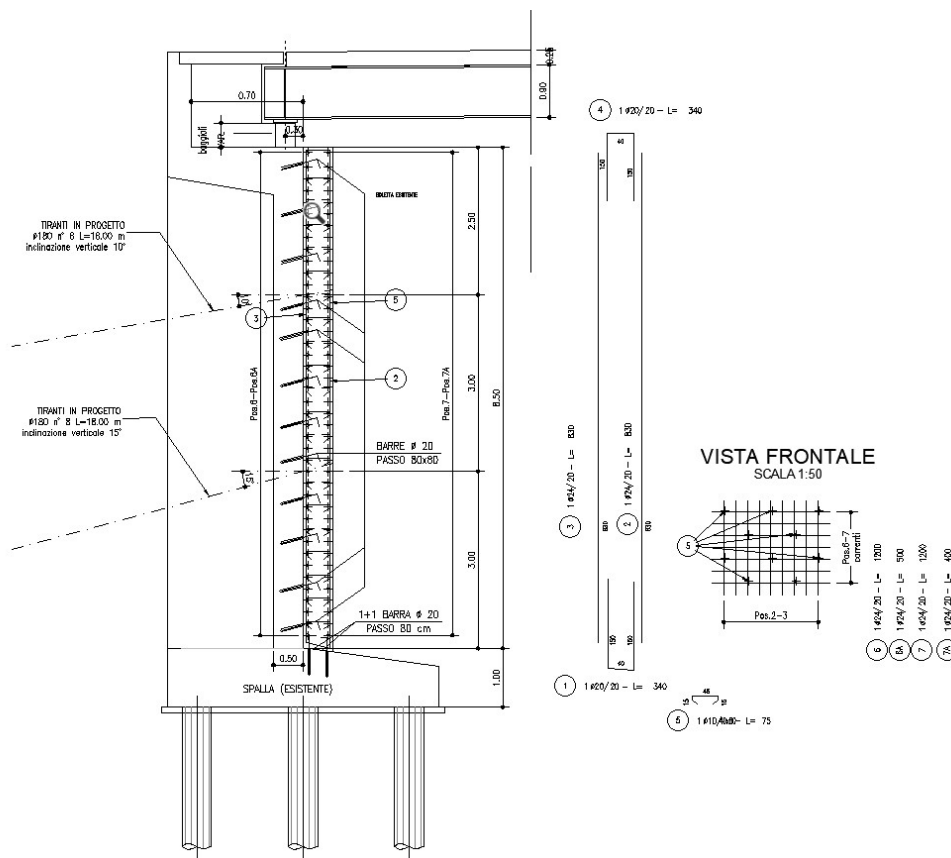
Spalle – Sezione tipo rinforzo strutturale
